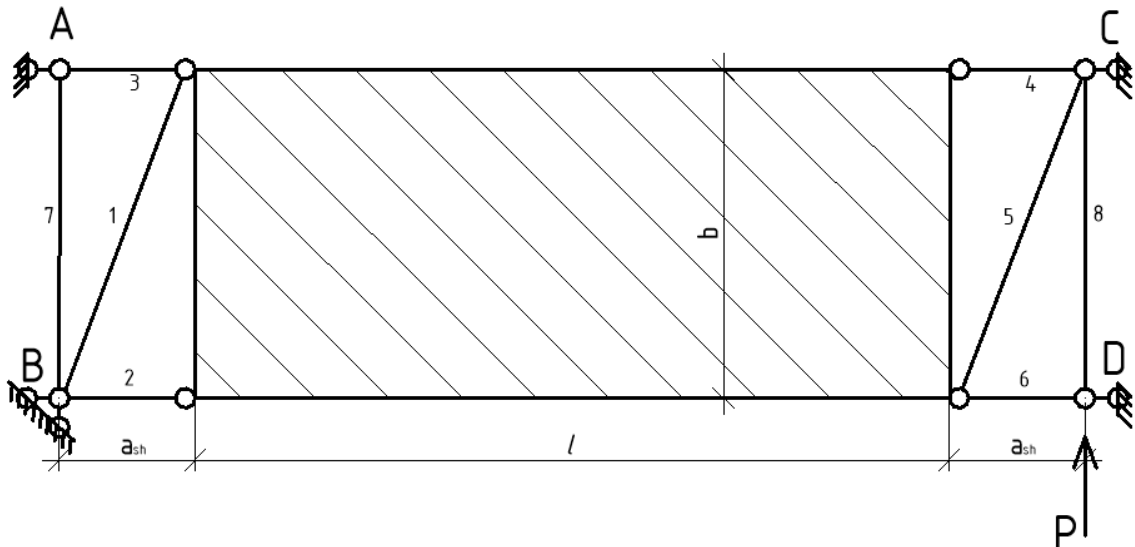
Расчетная схема для определения перемещений плиты или ячейки перекрытия от горизонтальной нагрузки, где:
